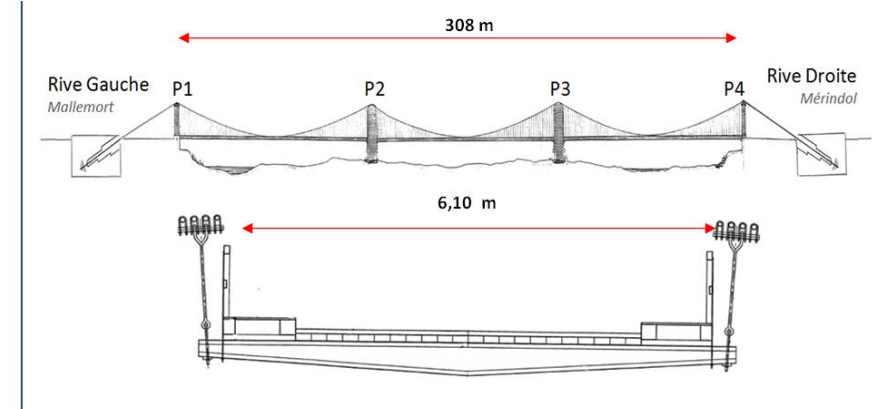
Vue en plan du pont suspendu de Mallemort (Source : CD13)
